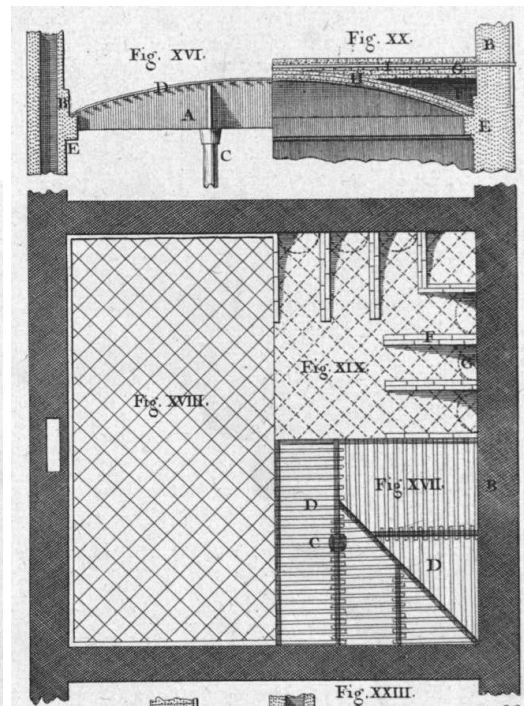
Voûte très surbaissée en brique, extrait de la planche LXXXXVII du cours de Blondel et Patte (1777b)
